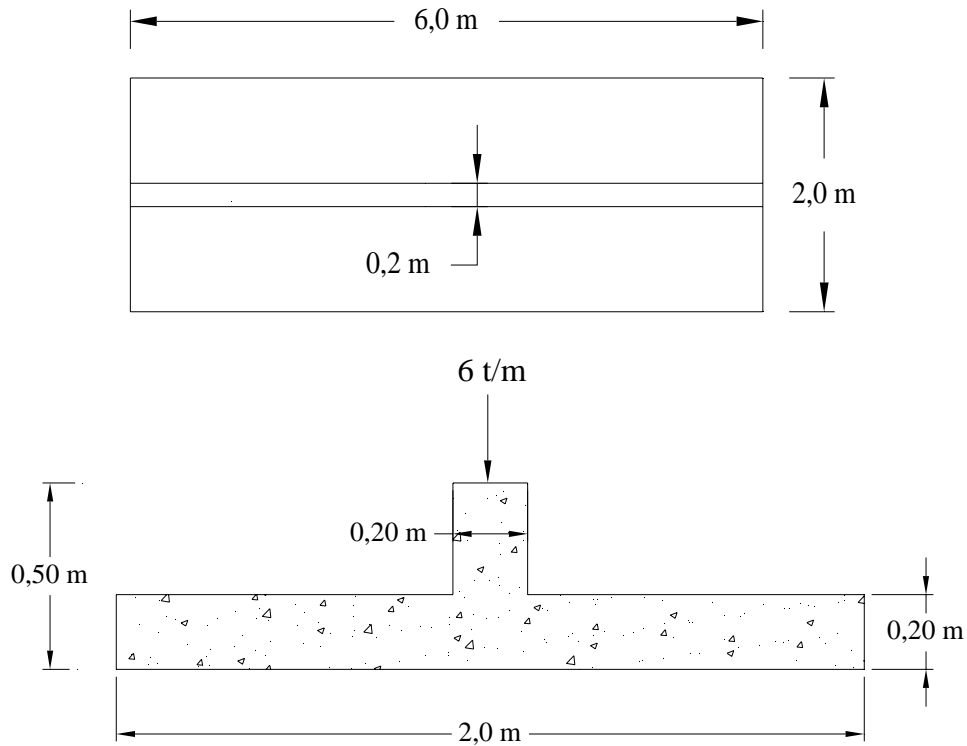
Dimensiones en planta y corte de zapata corrida
